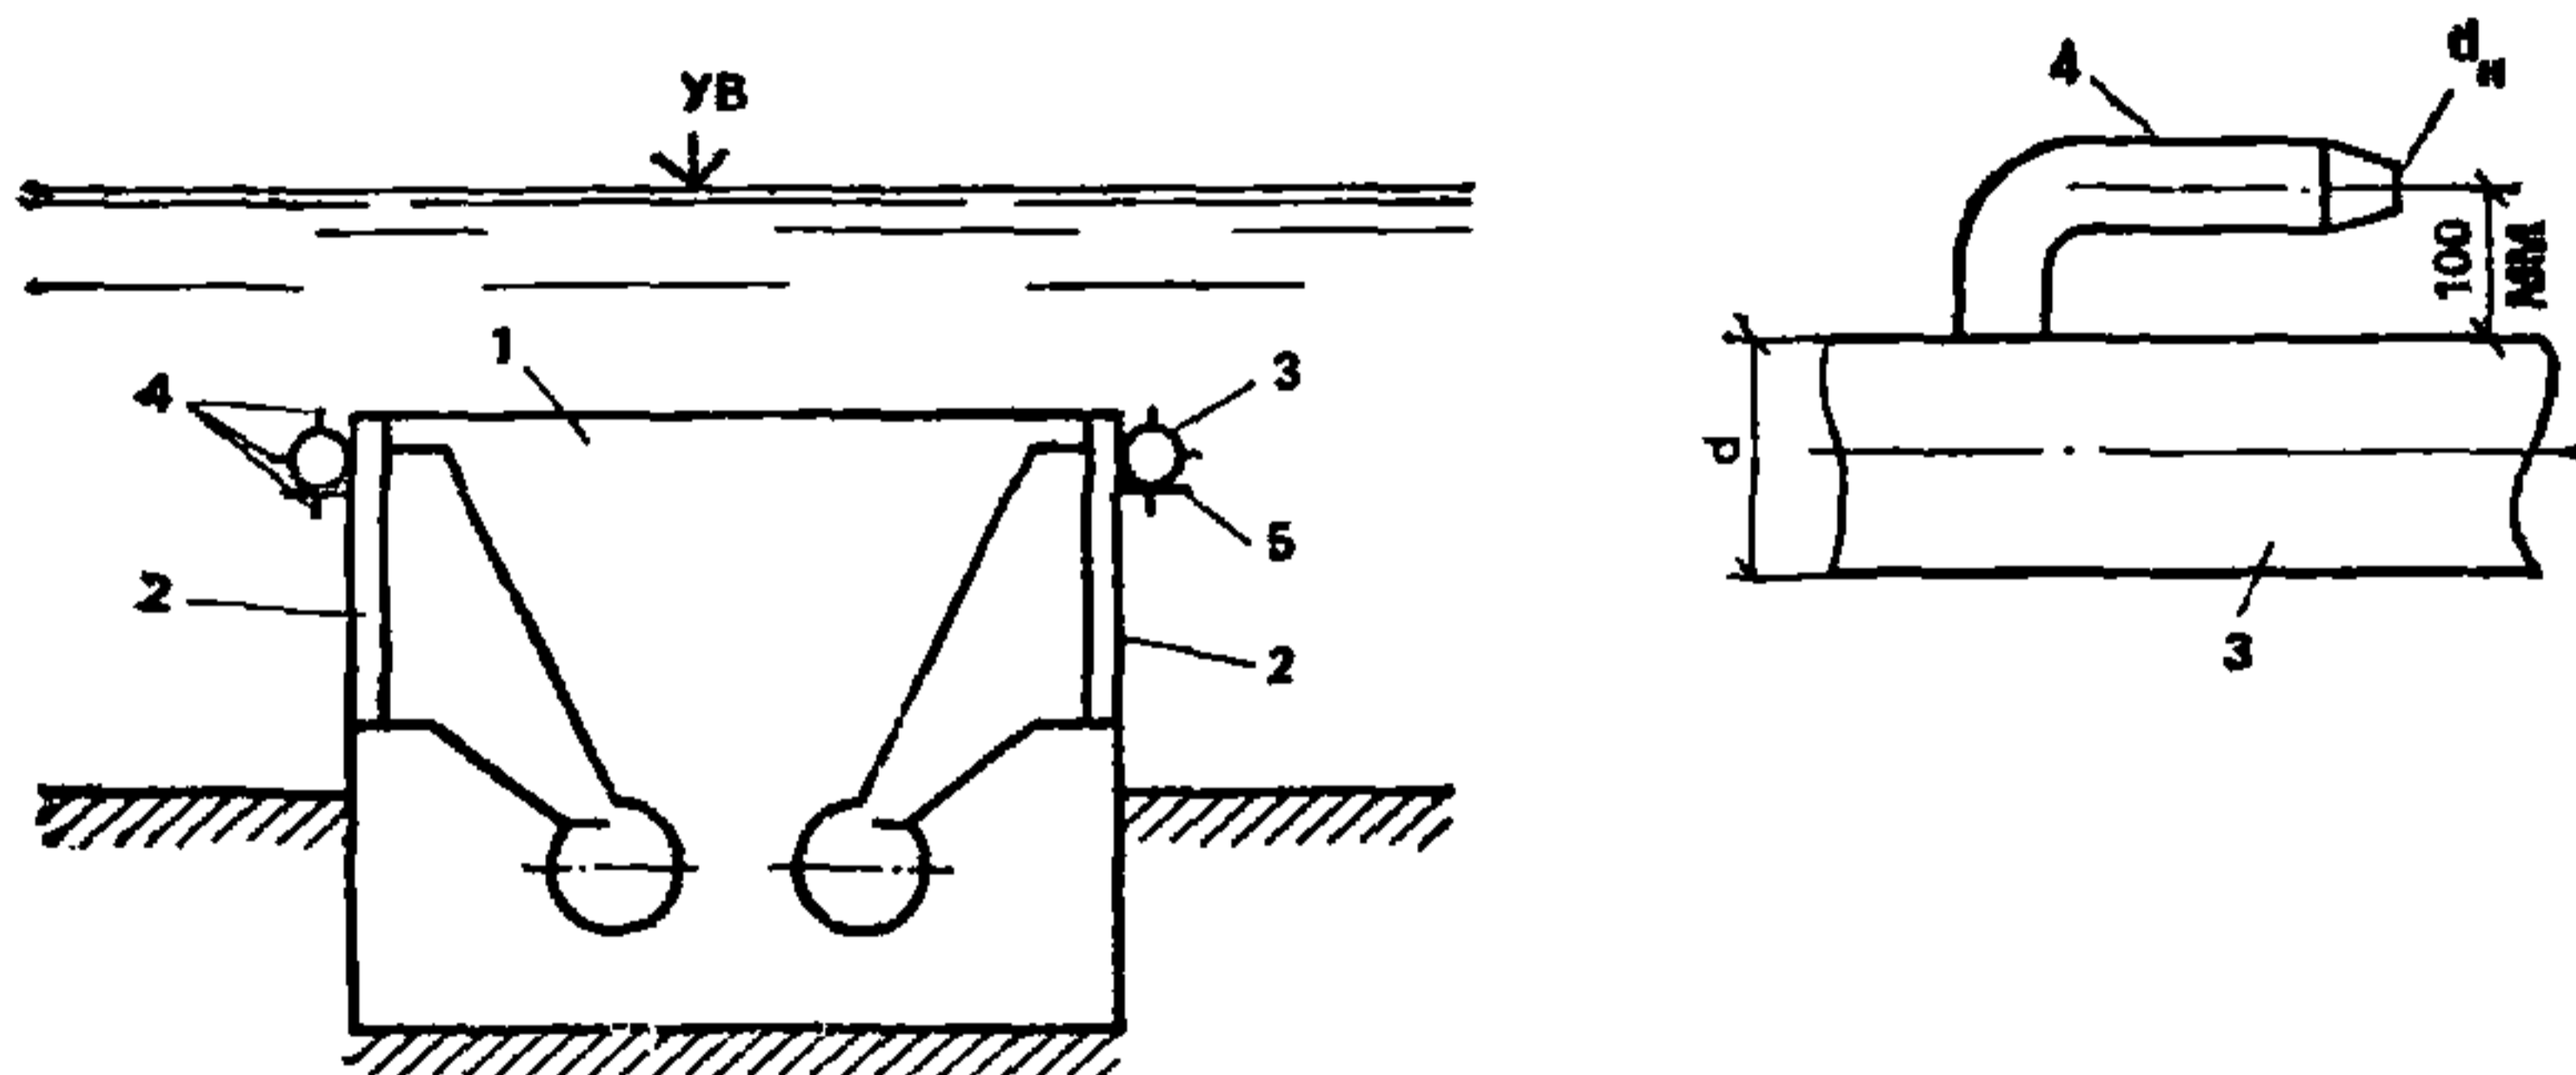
Схема размещения распределительного водовода на водоприемнике и присоединение насадка
